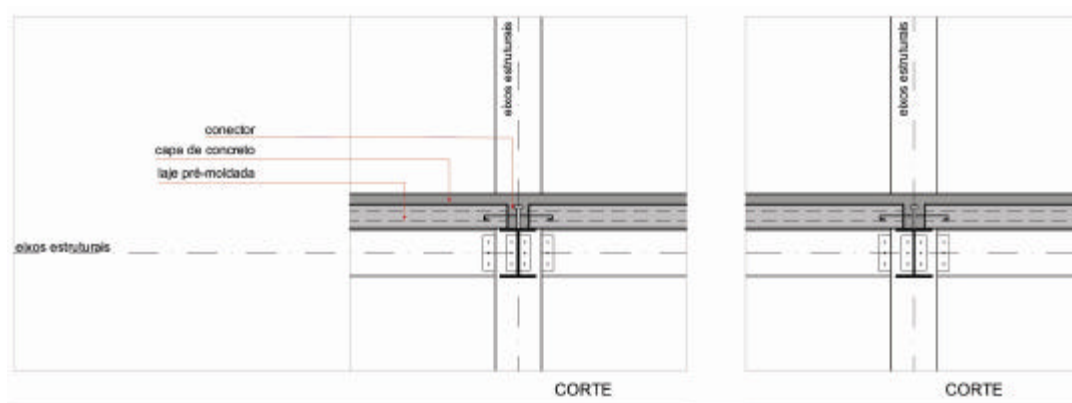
Detalhe construtivo - lajes pré-fabricadas protendidas.
